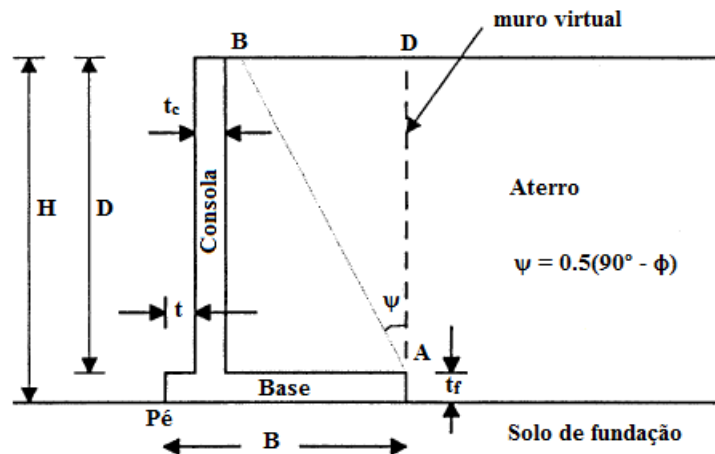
Geometria do muro de suporte em consola (adaptado de Goh, 1993)
